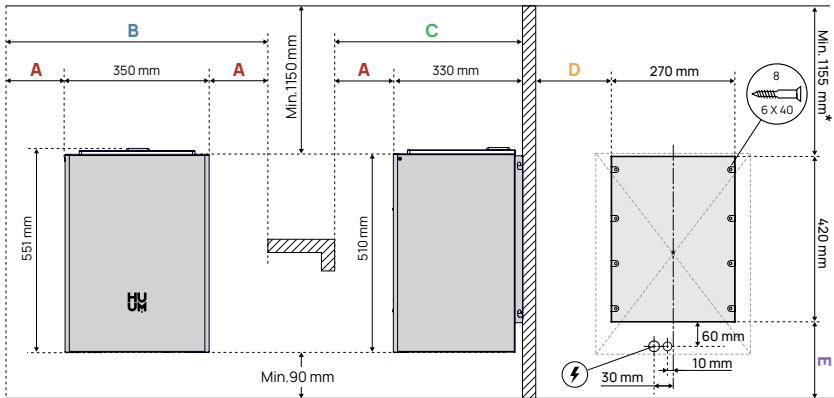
Pozicioniranje HUUM CORE Wall Combi
